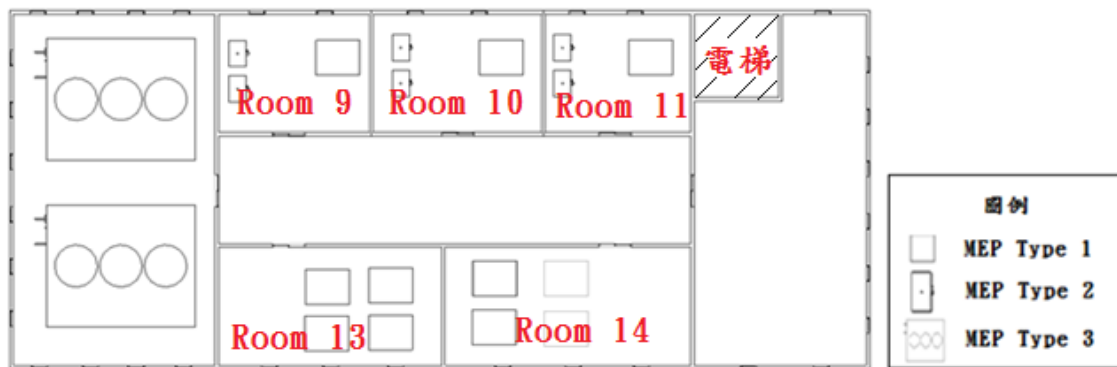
系統驗證之案例 Revit 模型- Level 2 平面圖 - 含施工電梯
